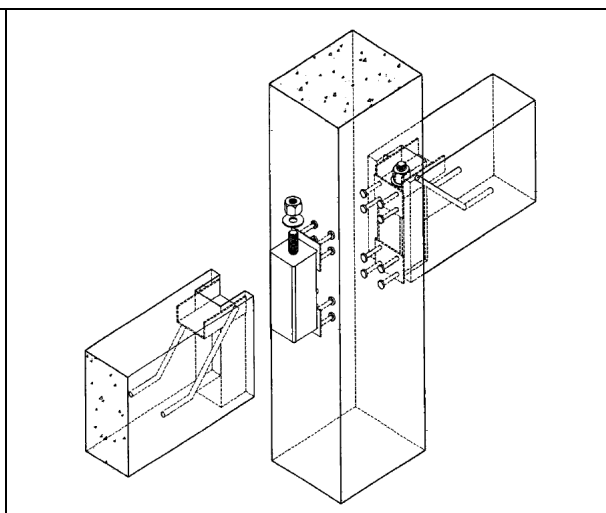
Ligação por consola curta metálica com armaduras em gancho (PCI, 1999)
